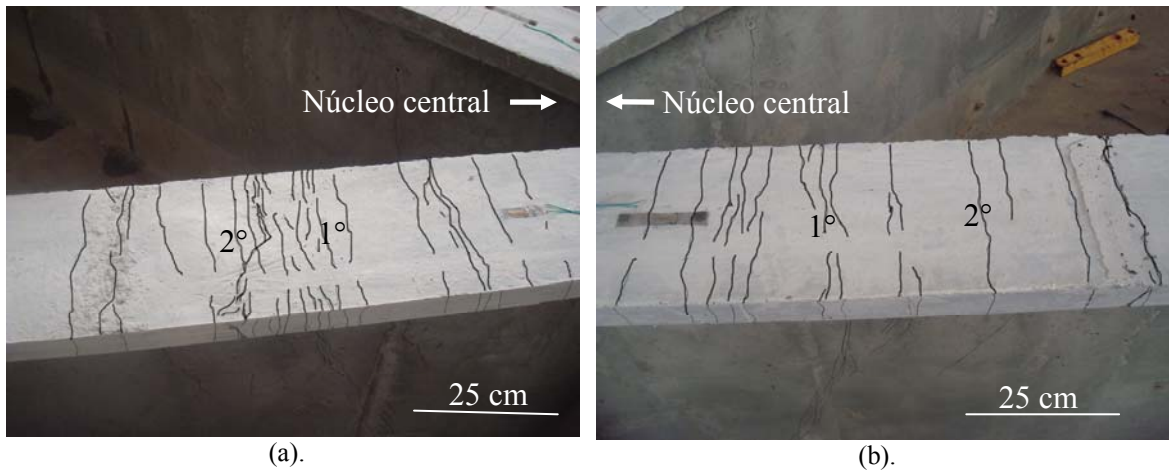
(a) Fissuração da mesa lado 01 e (b) Fissuração da mesa lado 02. As fissuras marcadas como 1° e 2° indicam a primeira e a segunda fissura observada nas mesas.
